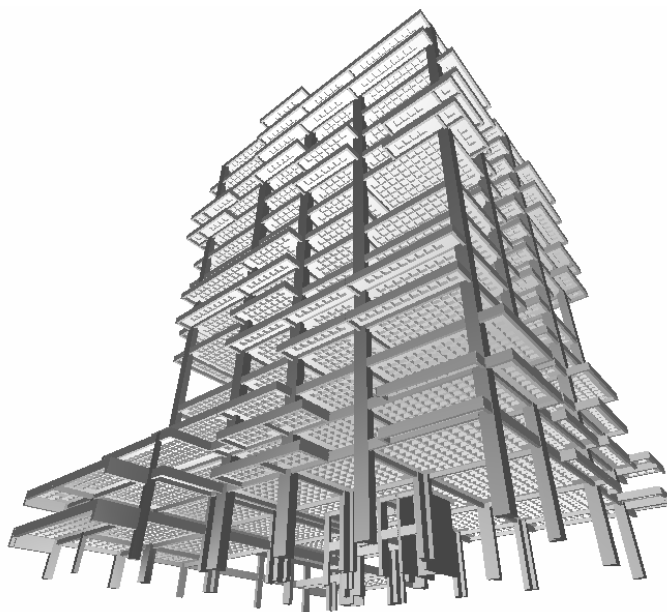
Modelo estrutural da Solução com Laje Nervurada em perspectiva inferior
